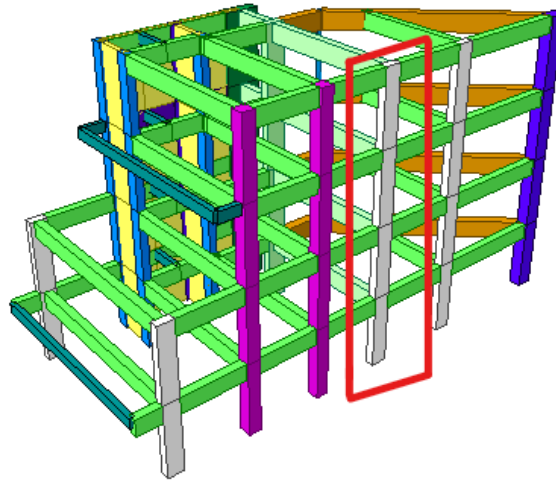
Esquema de columna en nivel 7 donde se propone el cambio de sección
